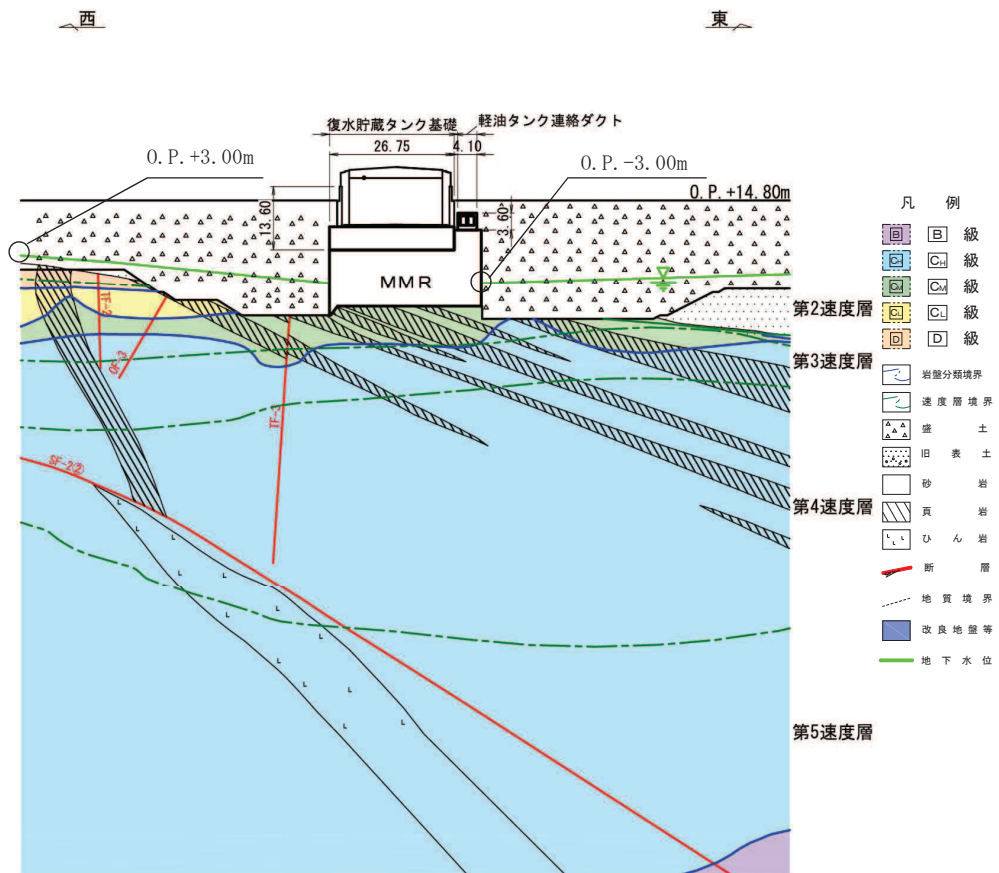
復水貯蔵タンク基礎 地震時荷重算出用地質断面図 (B-B 断面, 東西)
